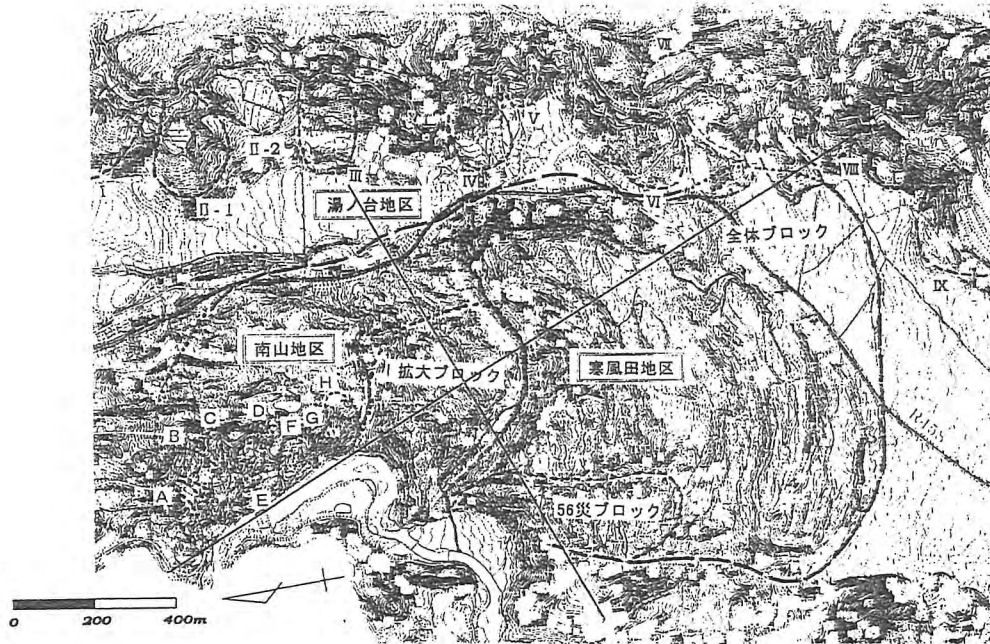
銅山川地すべり平面図 (図中の実線は縦横断面の位置を示す)
